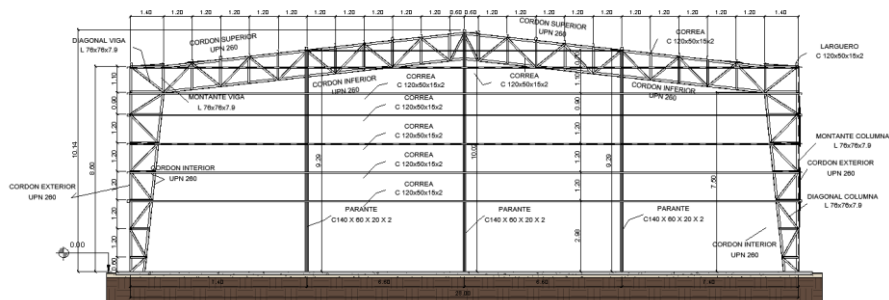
Vista pórtico extremo. Fuente: Elaboración propia.
